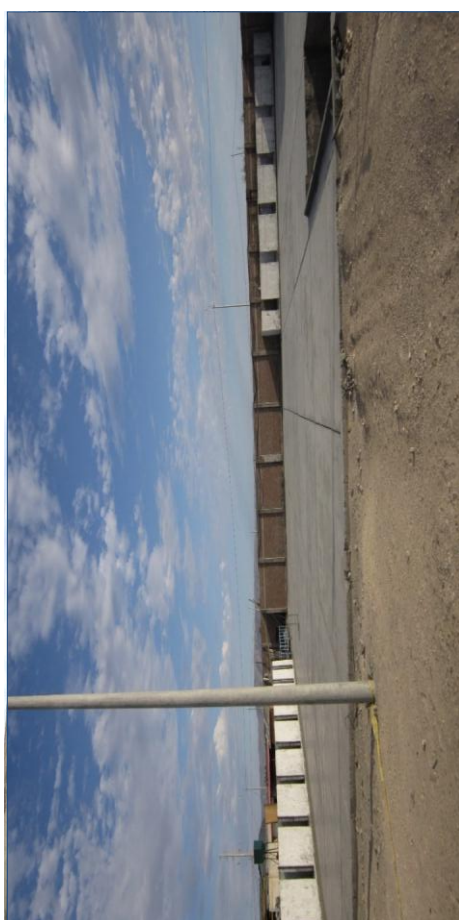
Loza de Concreto Armado Para el Secado Del Concentrado
